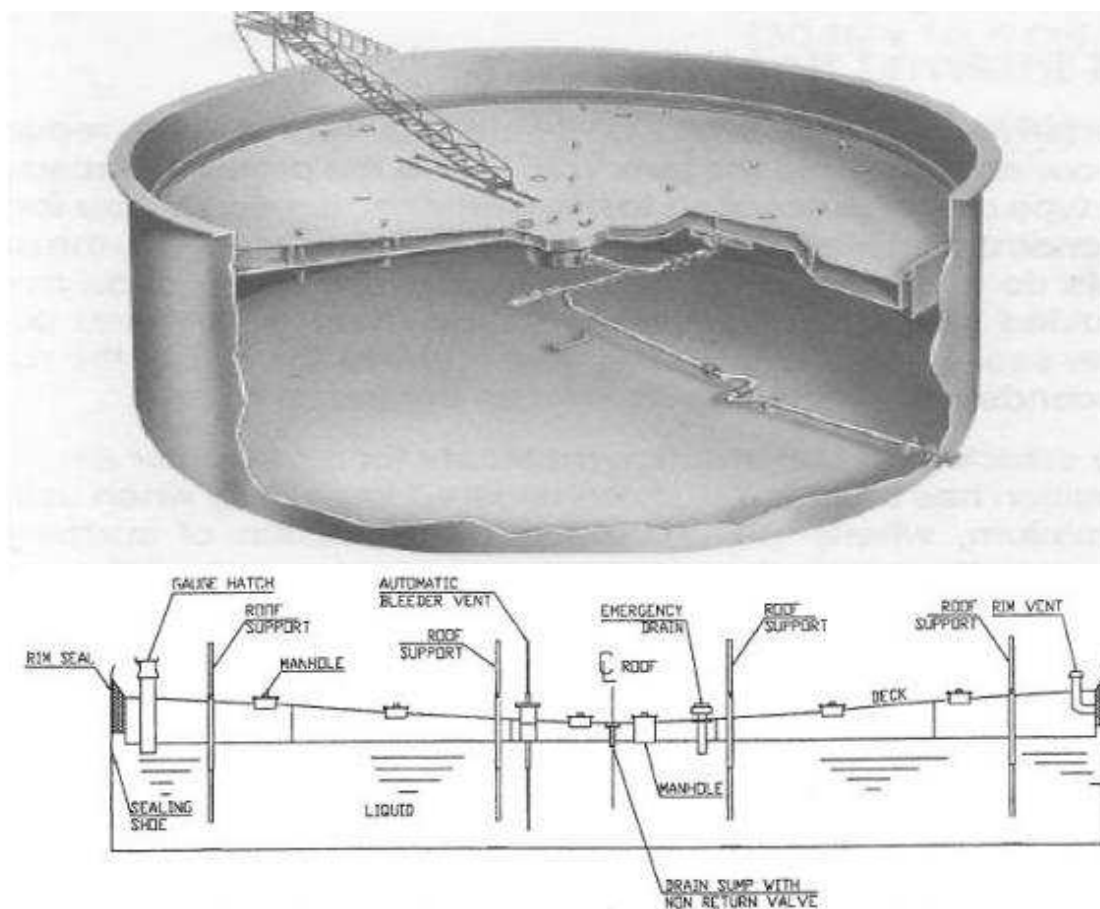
Резервуар с плавающей крышей двухпалубного типа [39].
